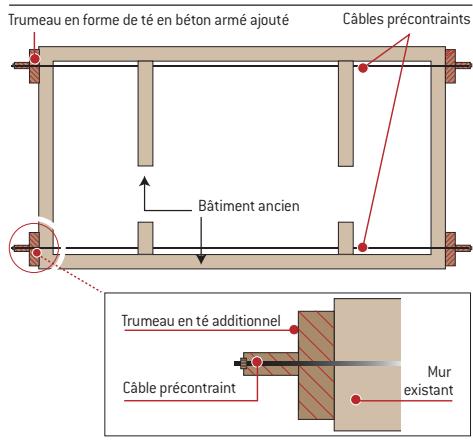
Exemple de renforcement par ajout de murs en béton à l'extérieur + serrage par précontraint [vue en plan]
